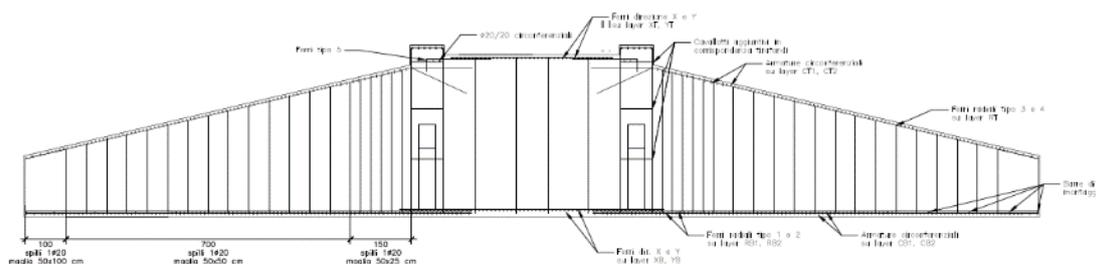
Sezione plinto di fondazione - identificazione armatura
